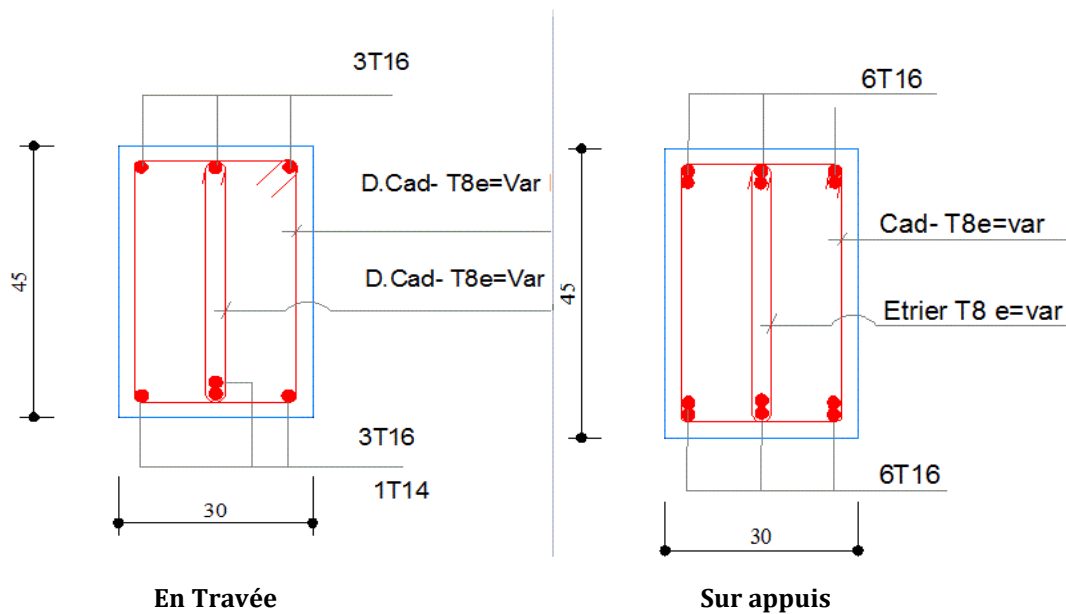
Ferrailage des poutres secondaires étage courant d'habitation 30\*45
